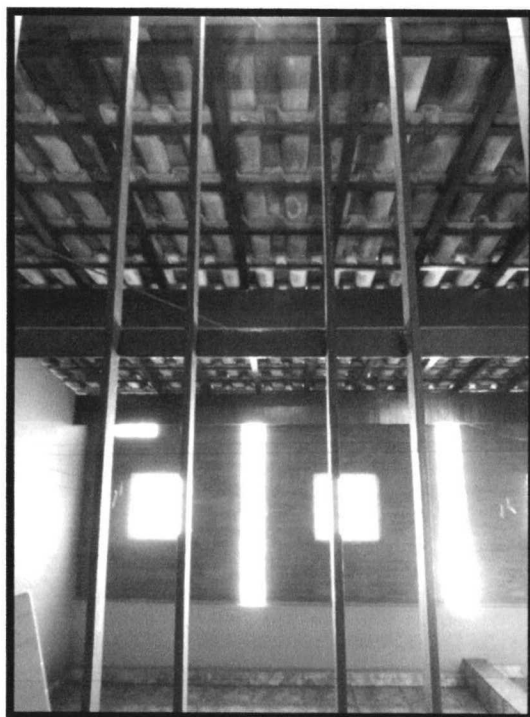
Área sobre garagem, vista a partir do dormitório nº 2
